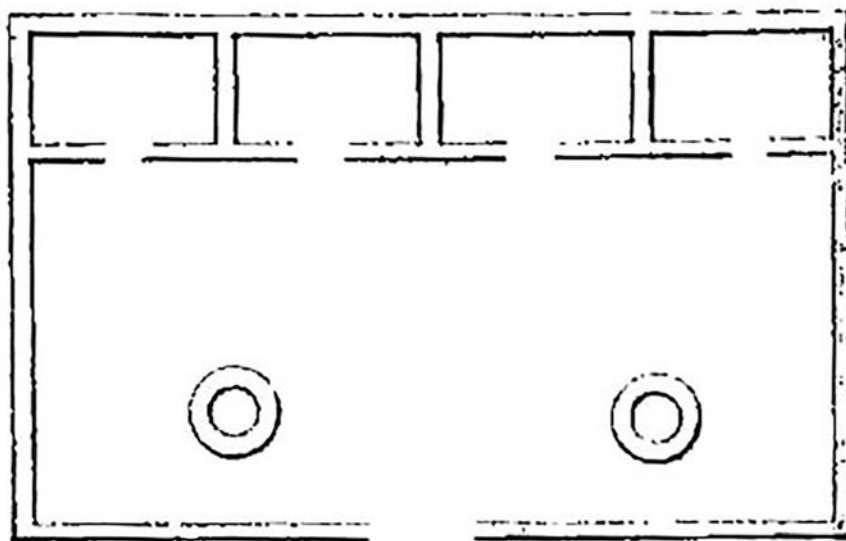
Plan d'une maison de Mtalsa (La Blanchère 1883, pl. VII, sans échelle).
